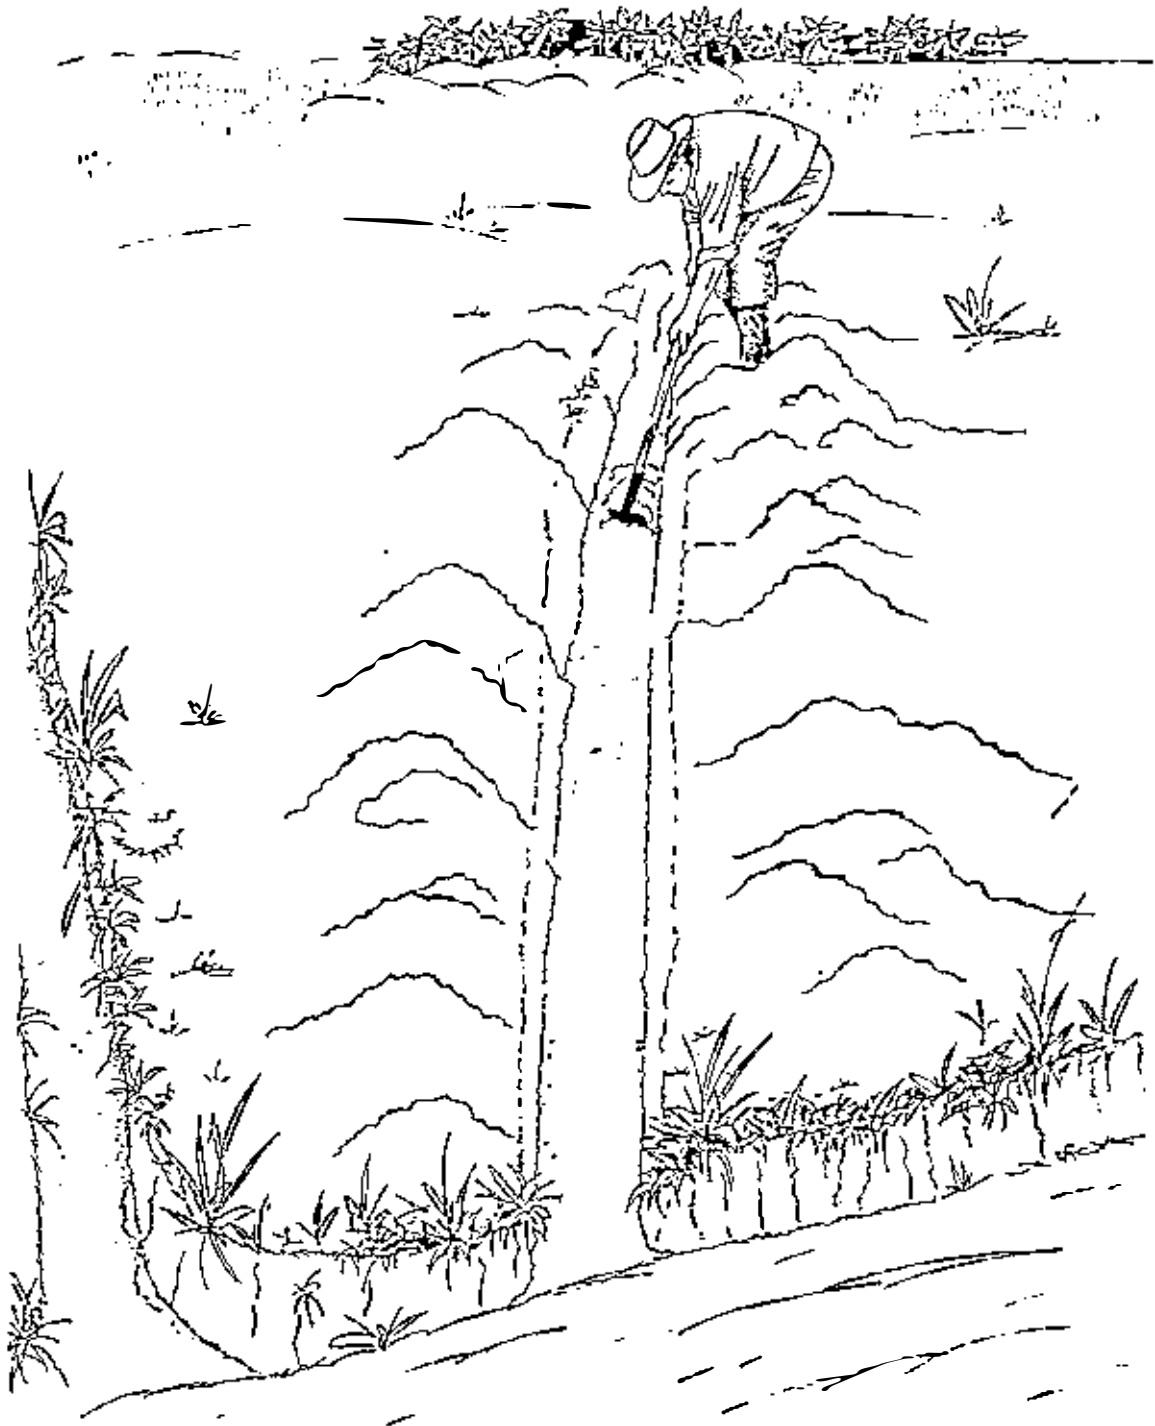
Excavación del zanjo para la construcción de la tahujia.
